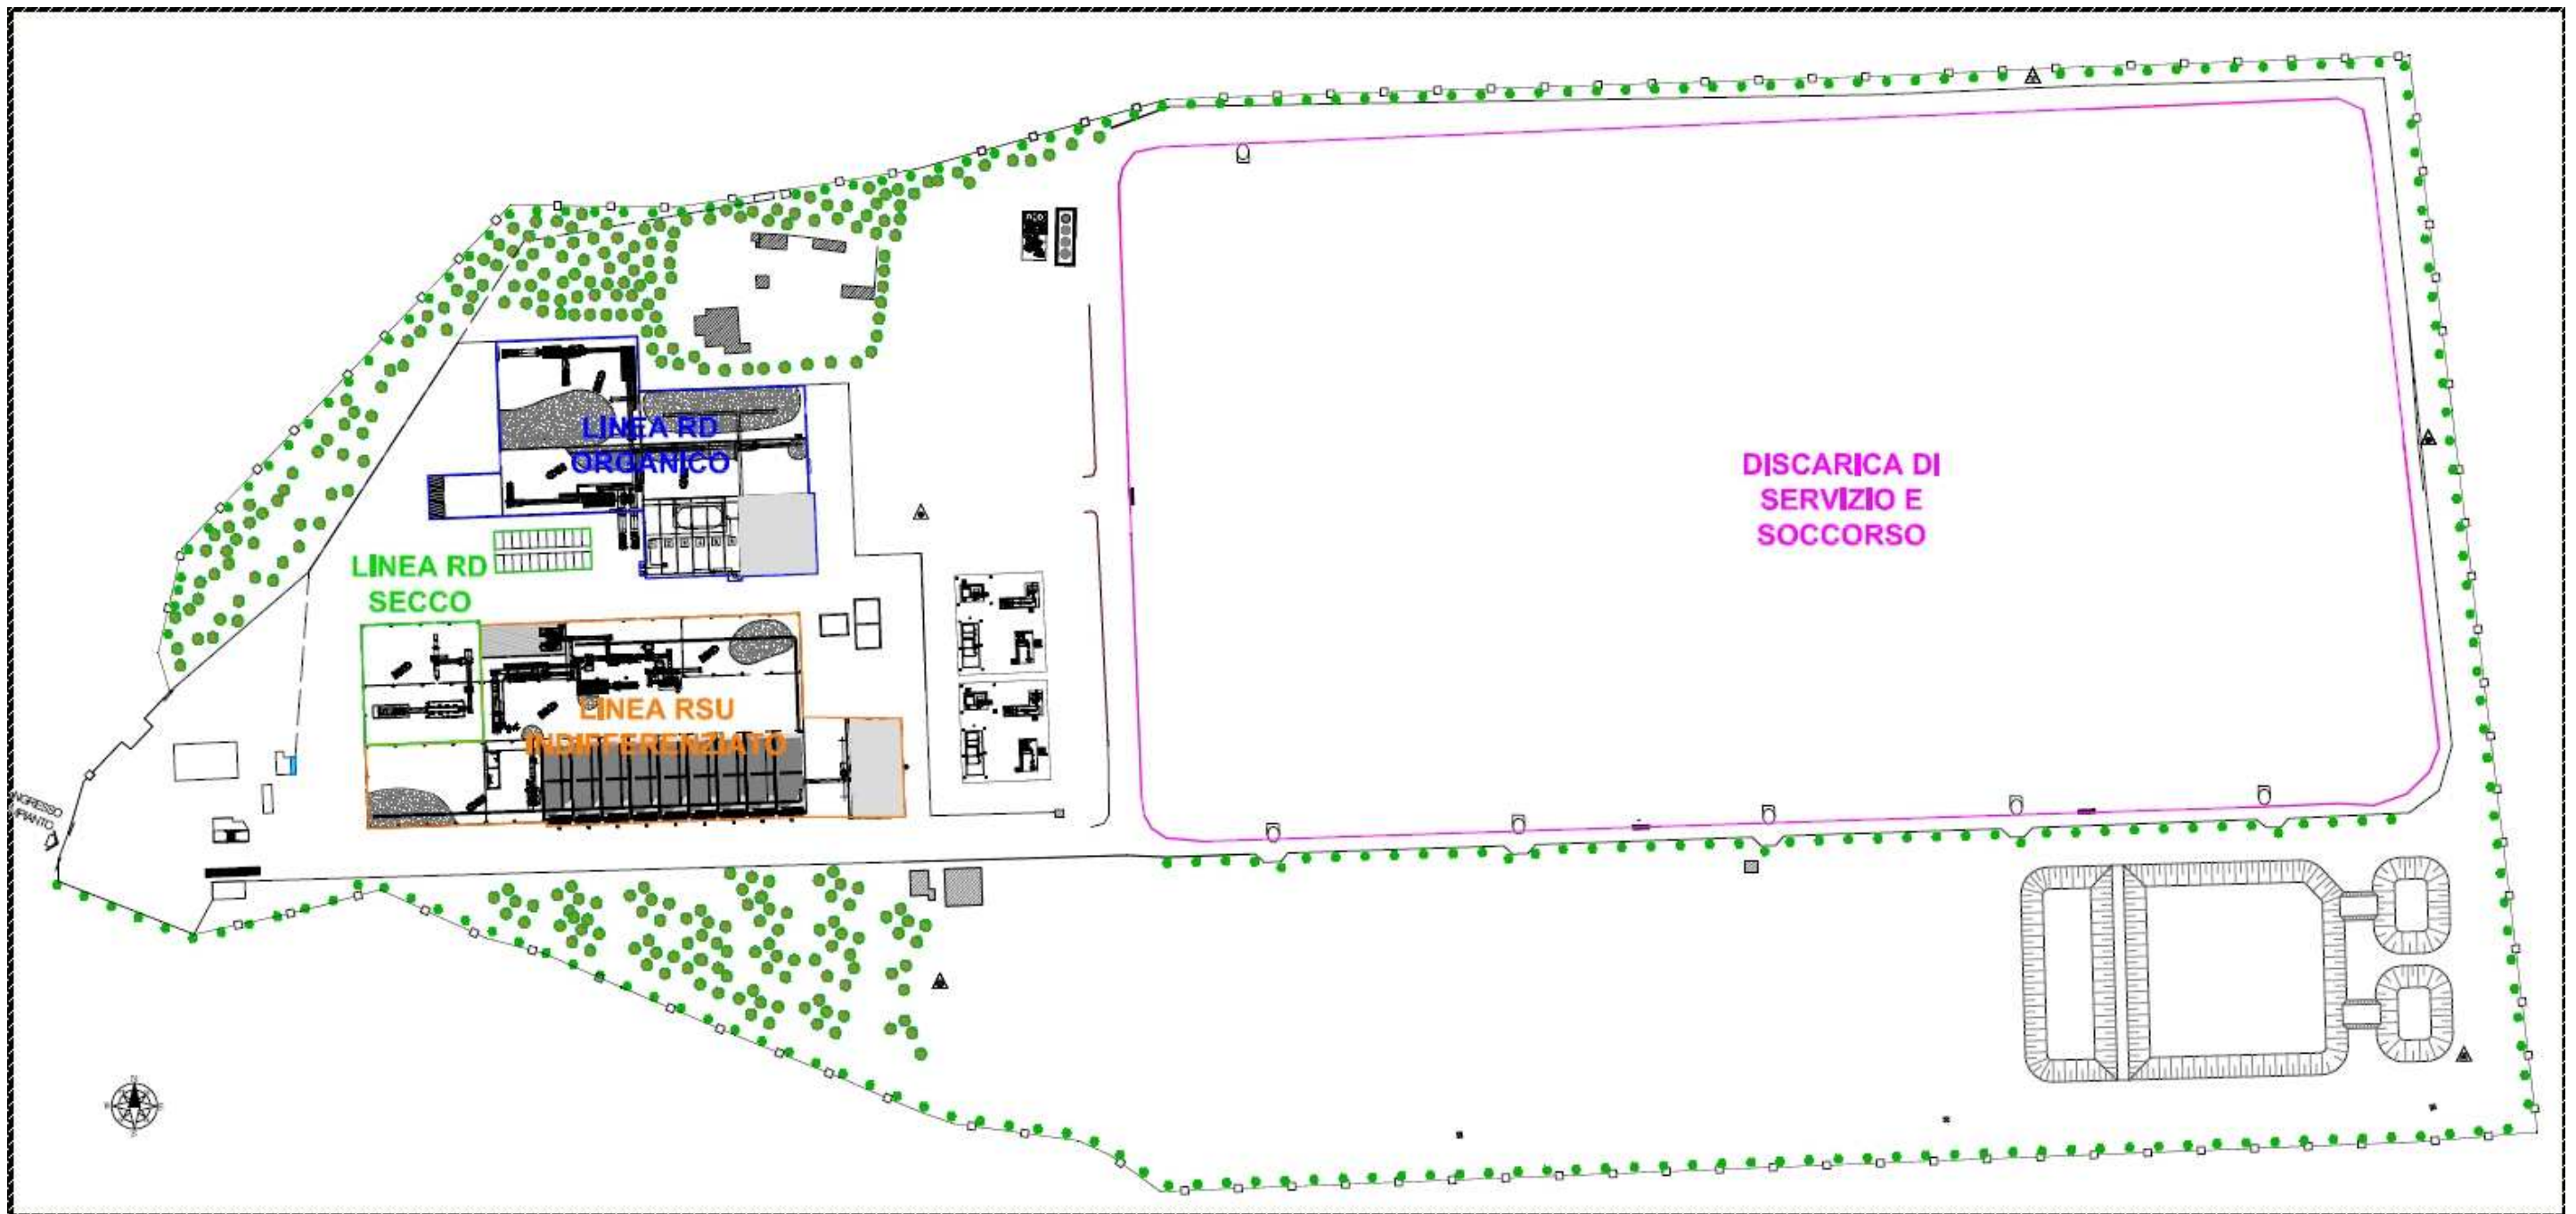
Planimetria generale del sito con ubicazione delle diverse linee impiantistiche
